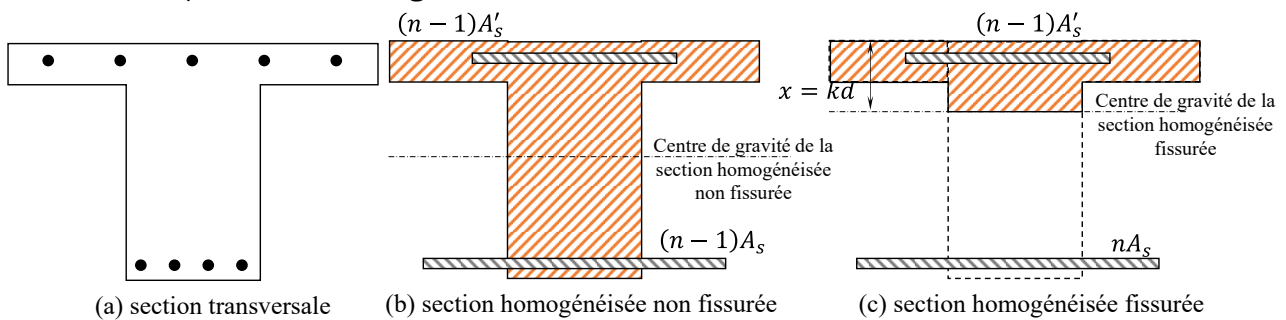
Section transformée homogénéisée de la poutre en T (a) section initiale, (b) section homogénéisée non fissurée, (c) section homogénéisée fissurée
